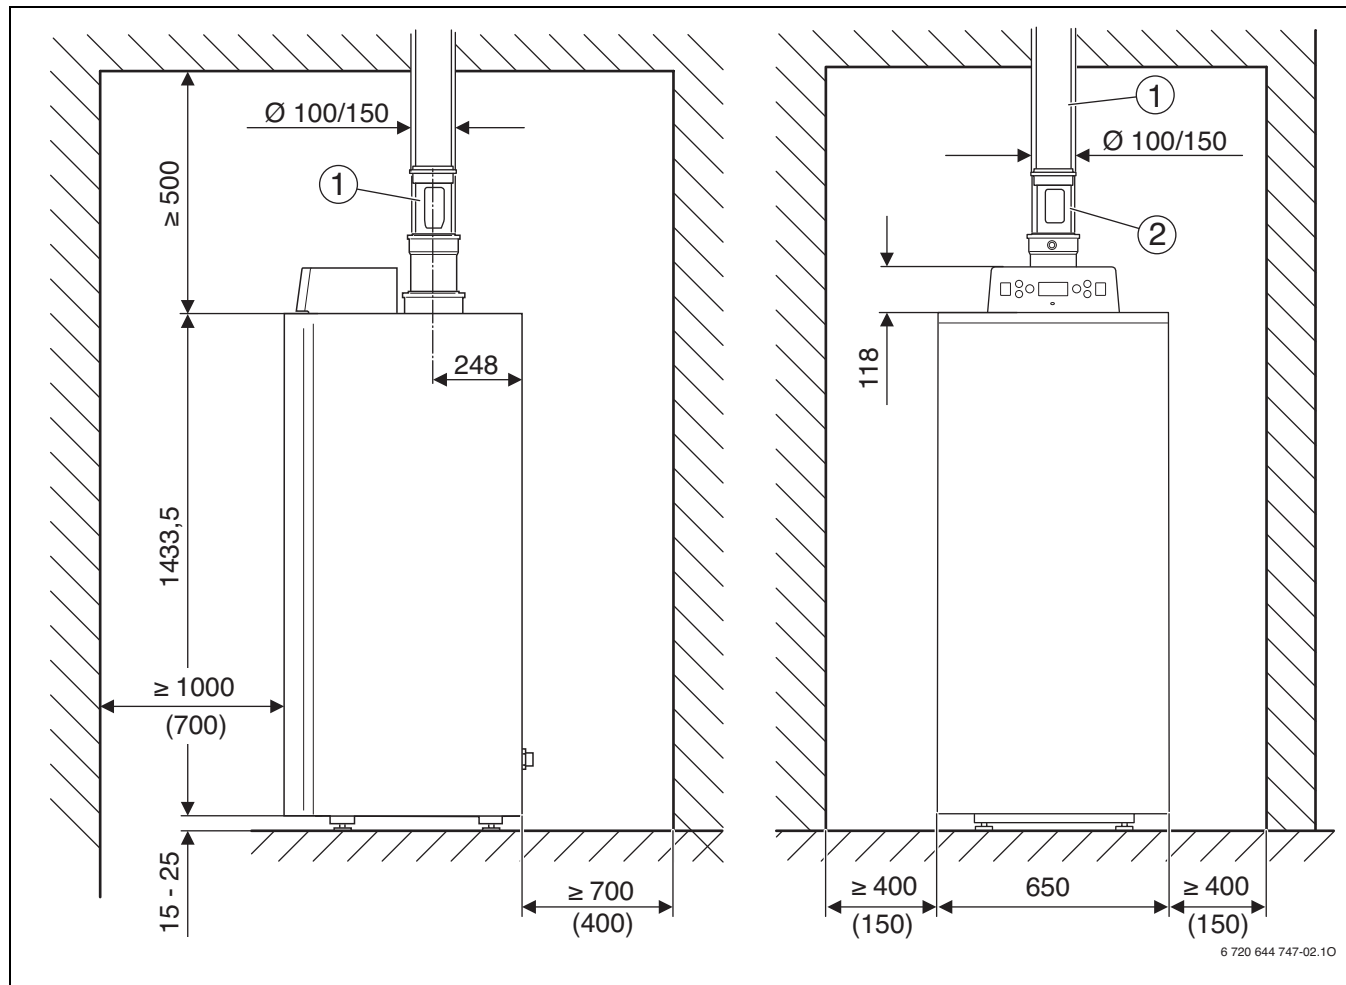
Inbouwmaten bij horizontale rookgasafvoer (de waarden tussen haakjes zijn minimale waarden)
